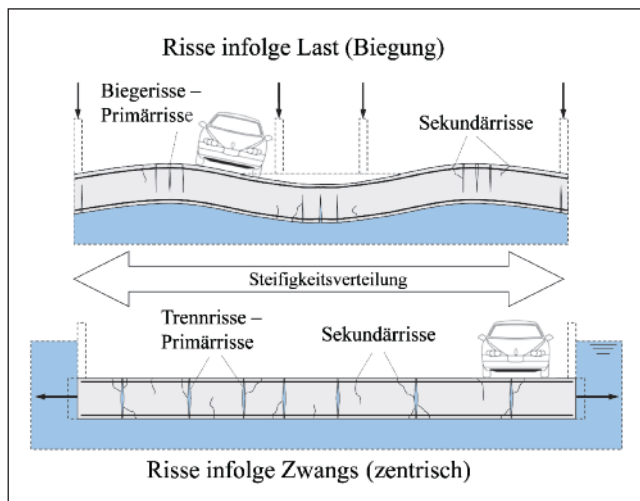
Haupttrissarten infolge Last- und Zwangsbeanspruchung
